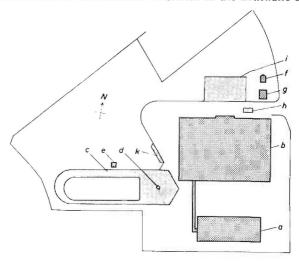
Grundriß und Lageplan des Instituts für Landtechnik
